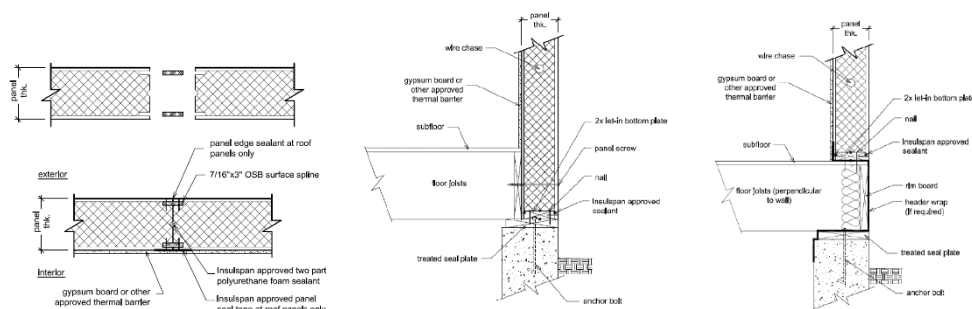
Ligação entre painéis SIP e ligação do pavimento à parede exterior (INSULPAN, 2015).
